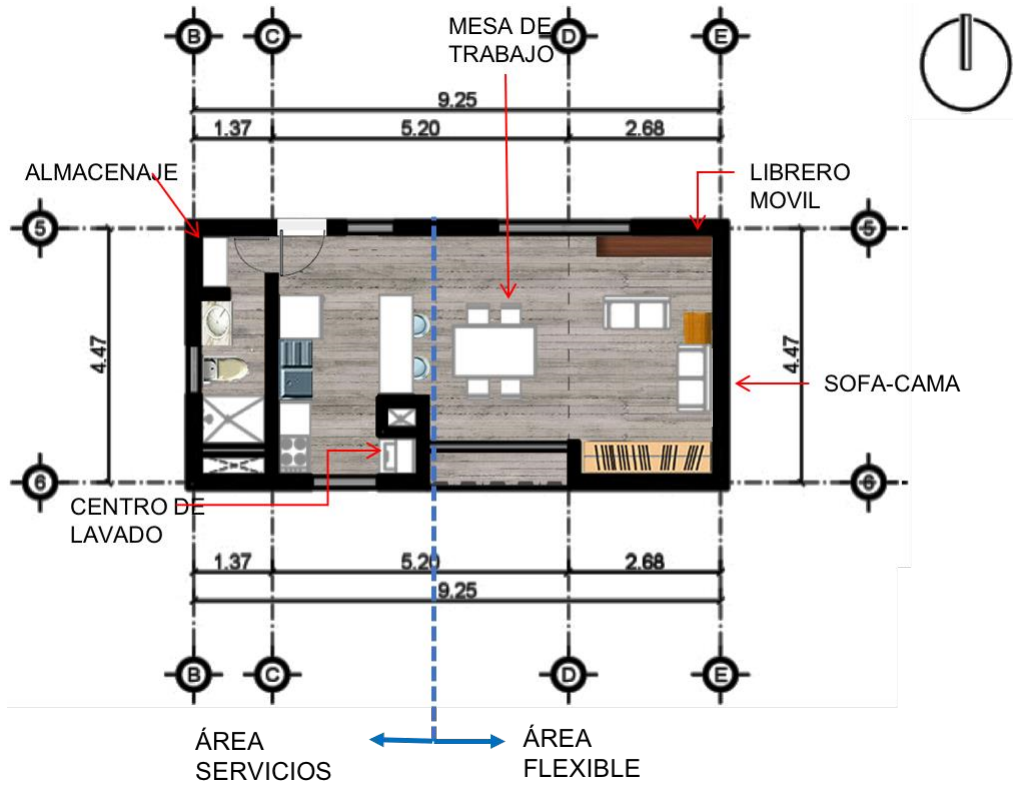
Prototipo Unipersonal, planta libre y flexibilidad. Sin escala, Fuente: Elaboración Propia
